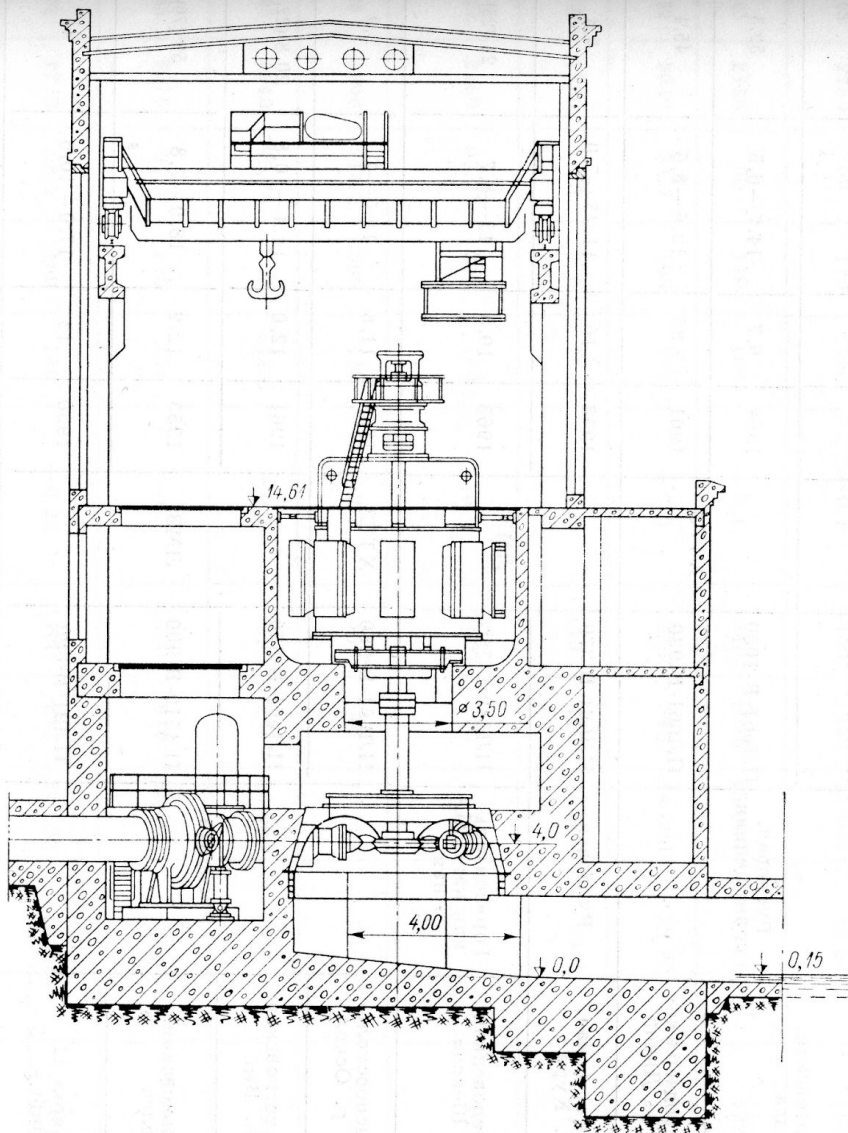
Установка агрегата Татевской ГЭС (поперечный разрез)
